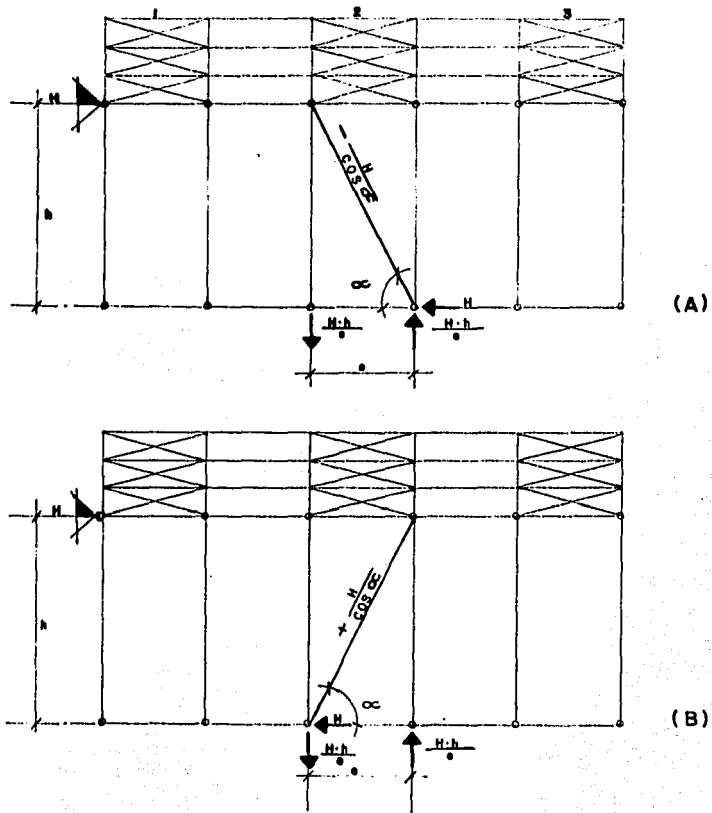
Disposición del contraventeo en muros laterales
